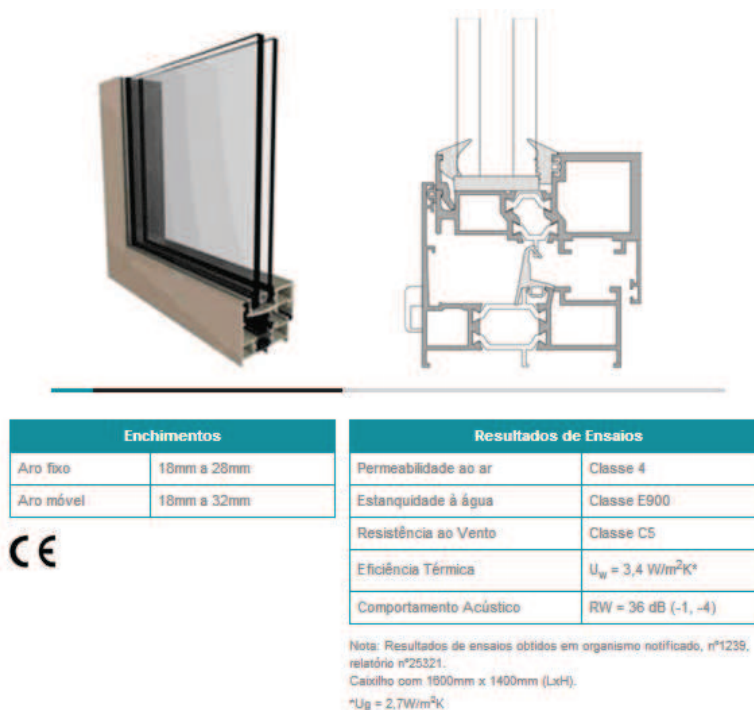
Propriedades da caixilharia Arkial Bzi Oculto definido em projeto (Sapagroup)
